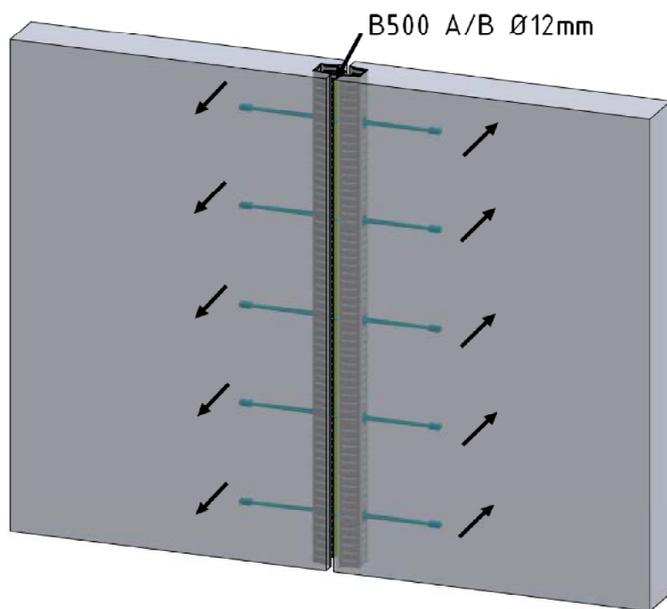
Beanspruchung senkrecht zur Fugenlängsrichtung und Wandebene
